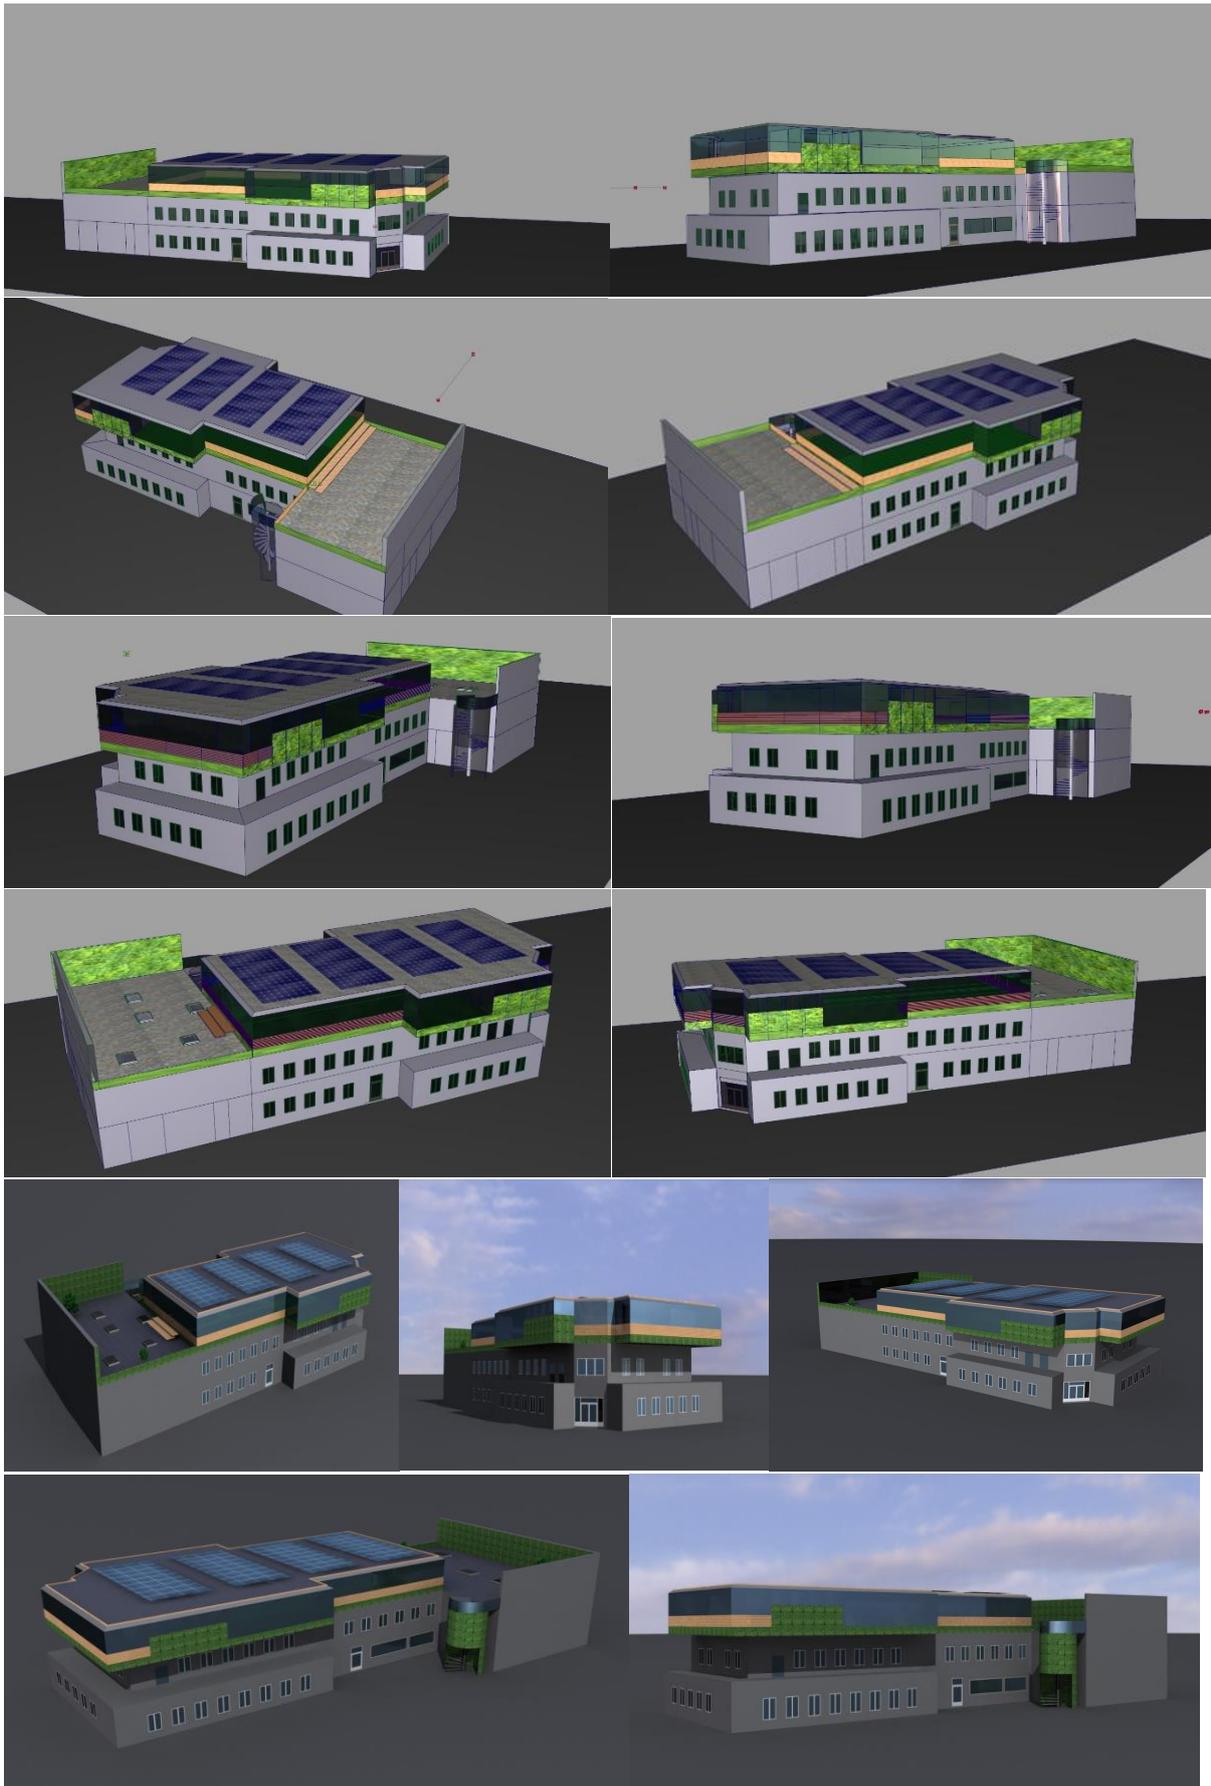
Solar PV Elemente am Dach des Haupthauses plus Fassadengestaltung in Farbgebung und Holz mit Fassadenanimation
